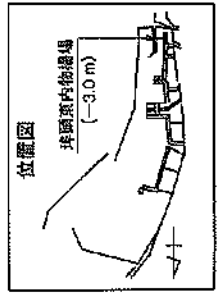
奥尻港埠頭東内物揚場の被災断面図
